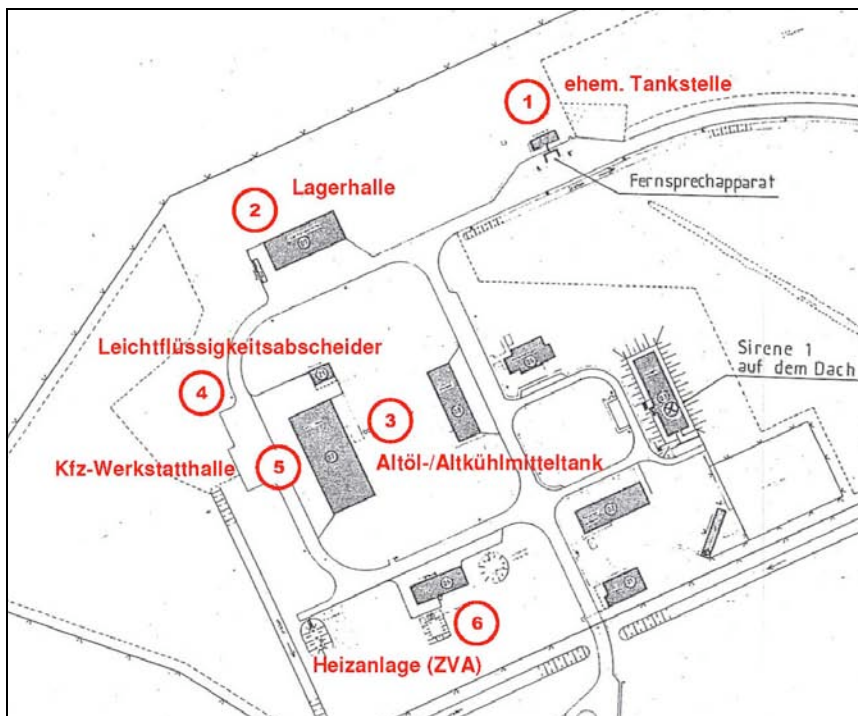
Lageplan kontaminationsverdächtiger Flächen
